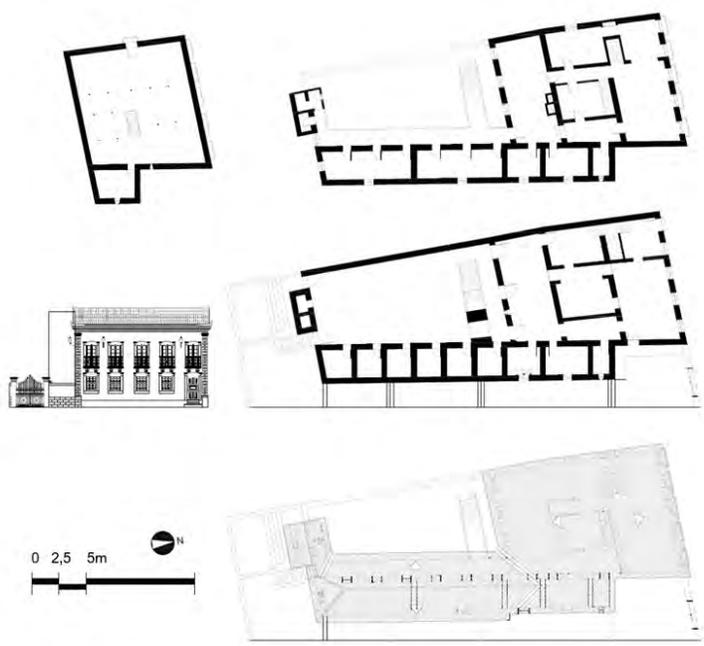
Planta baixa do antigo Solar do Marinheiro Jorge. Fonte: Acervo IPHAN-PB.
